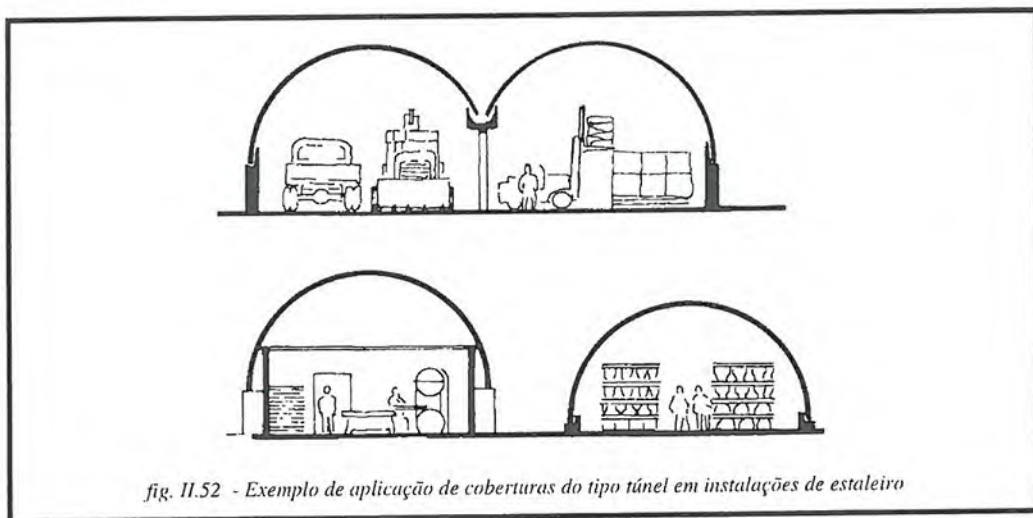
Exemplo de aplicação de coberturas do tipo túnel em instalações de estaleiro
